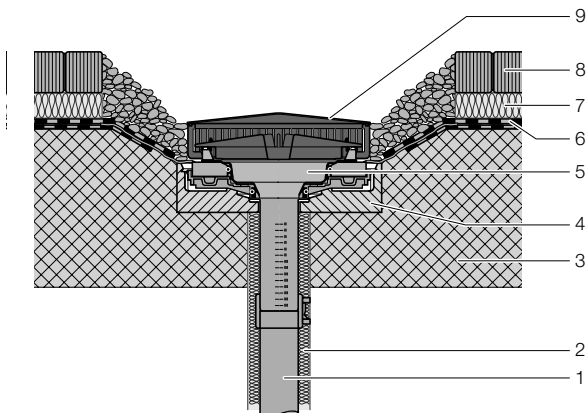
Конструкция монолитной кровли, не изолированной, с битумным кровельным покрытием, пригодным для передвижения людей
